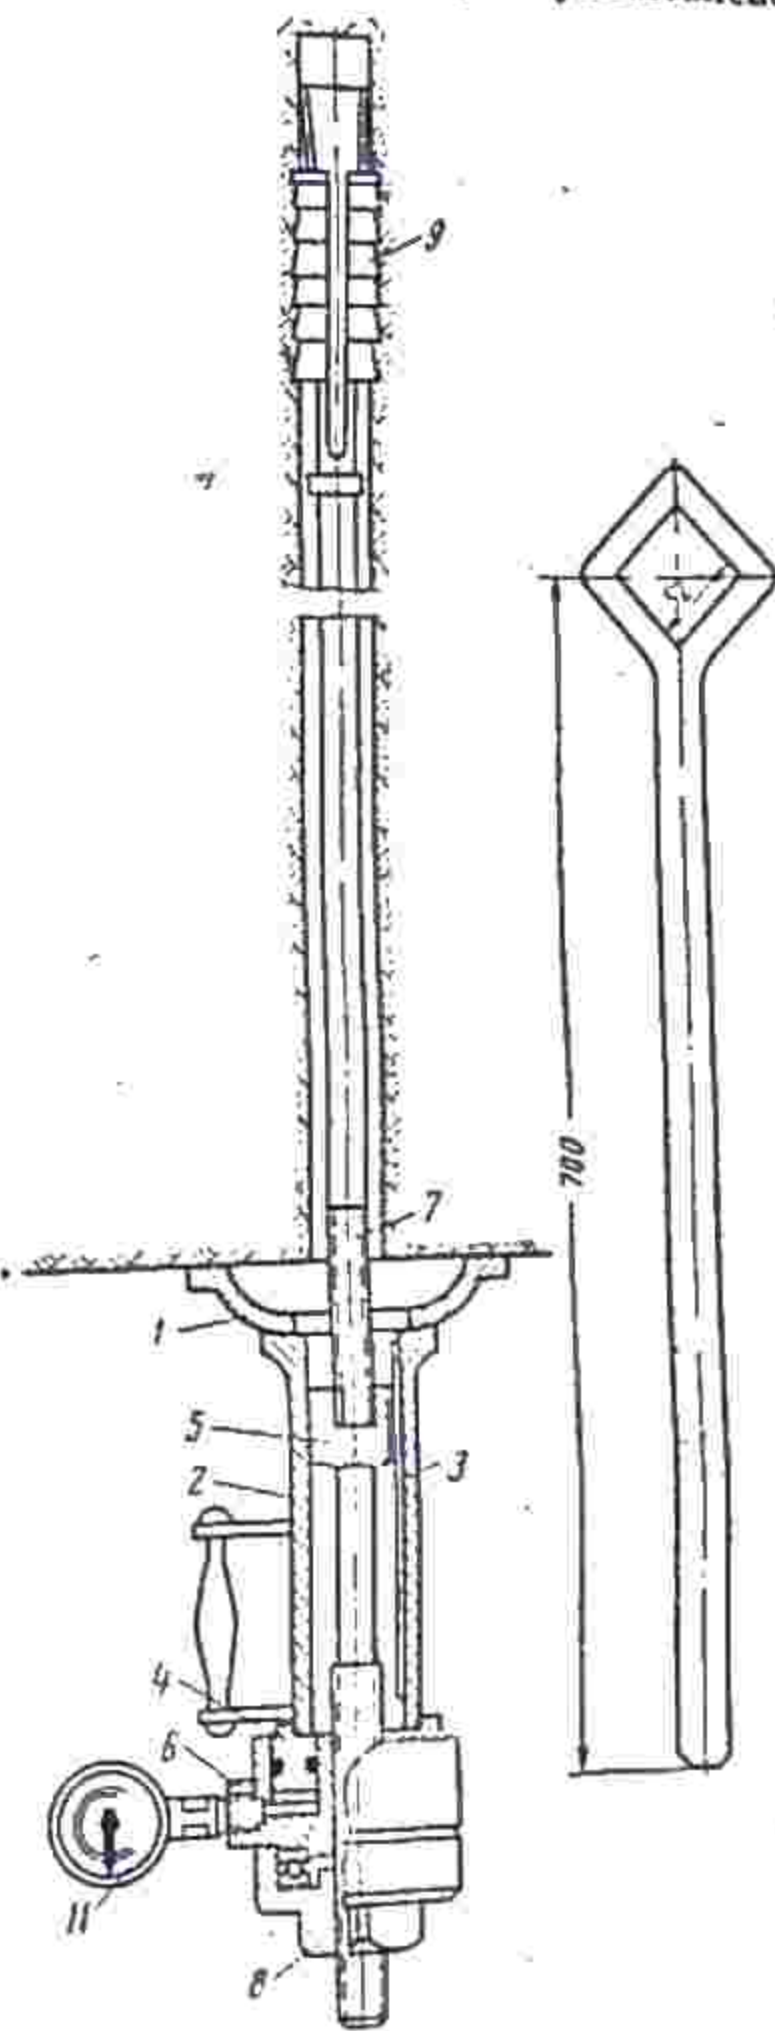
Прибор ПА-3 для определения прочности раскрепления замковых штанг
